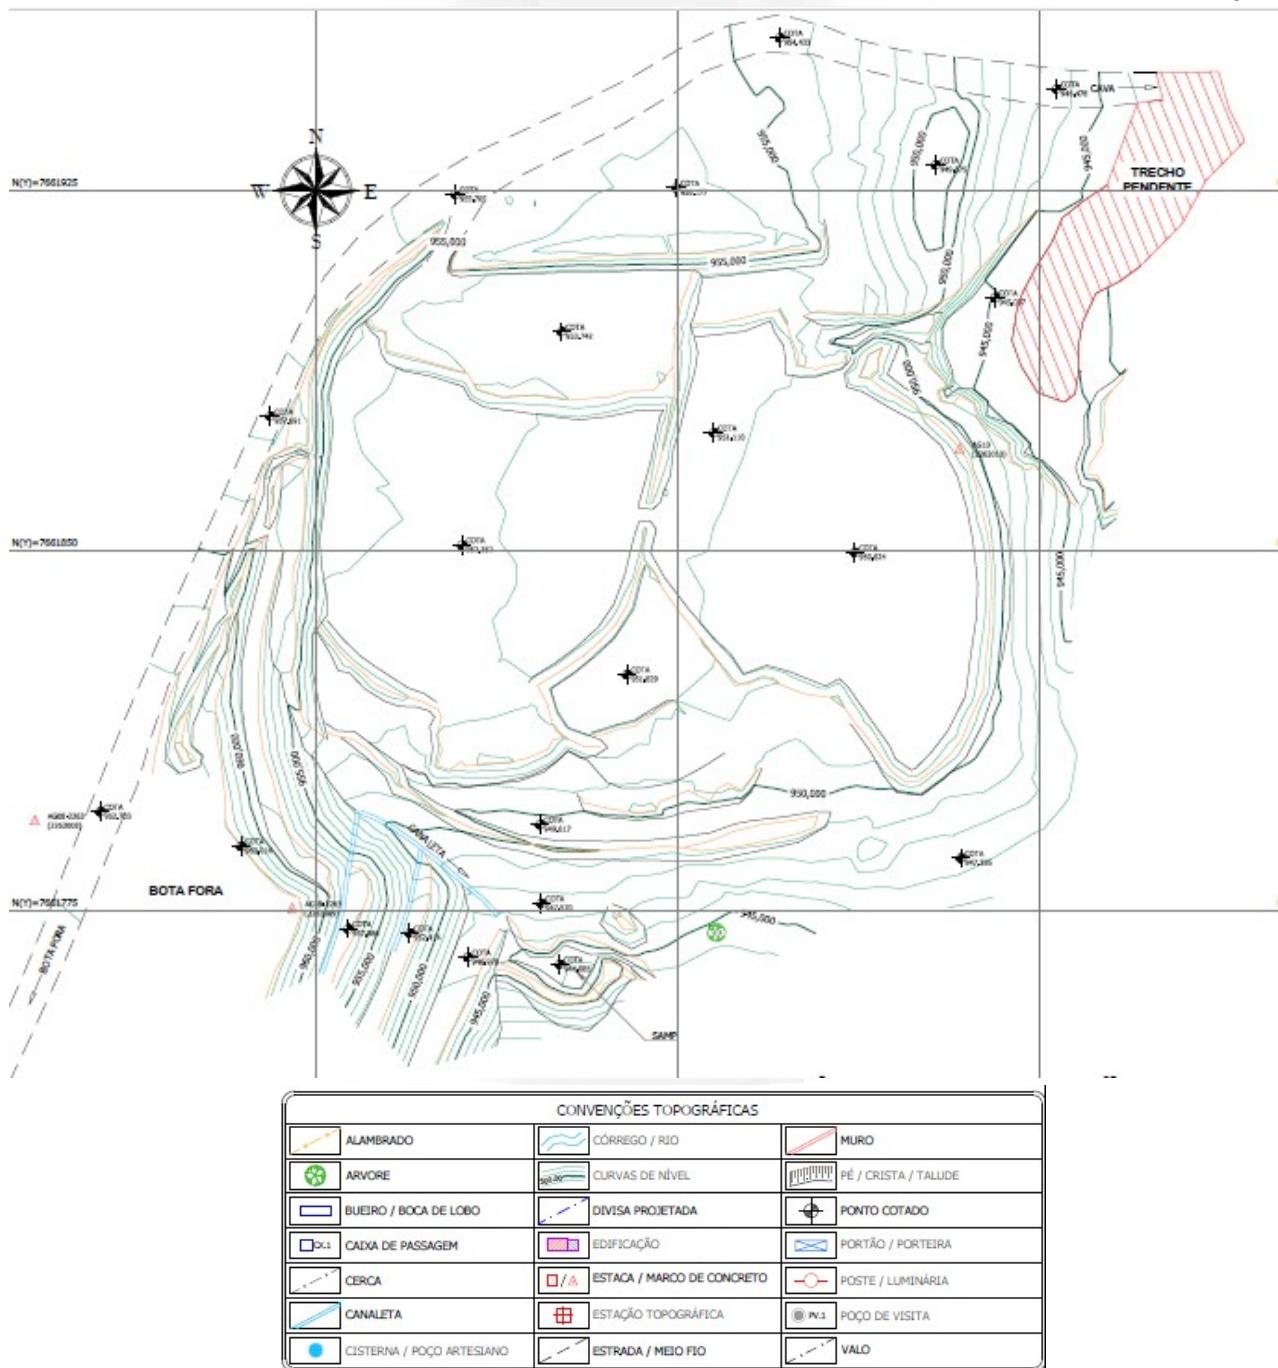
levantamento planimétrico da pilha, o trecho pendente não foi considerado no projeto, resposta da IC.
